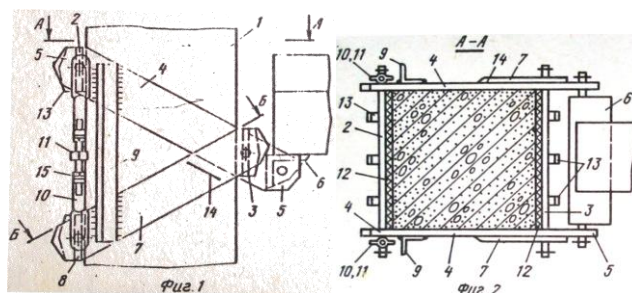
Опорное устройство на колонны, по изобретению автора [13]: *фиг. 1* – крепление устройства к железобетонной колонне с приложением нагрузки, вид сбоку; *фиг. 2* – сечение А-А на *фиг. 1*.
